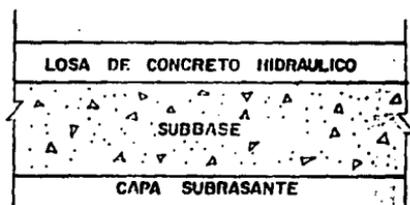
CAPAS QUE FORMAN UN PAVIMENTO RÍGIDO.
